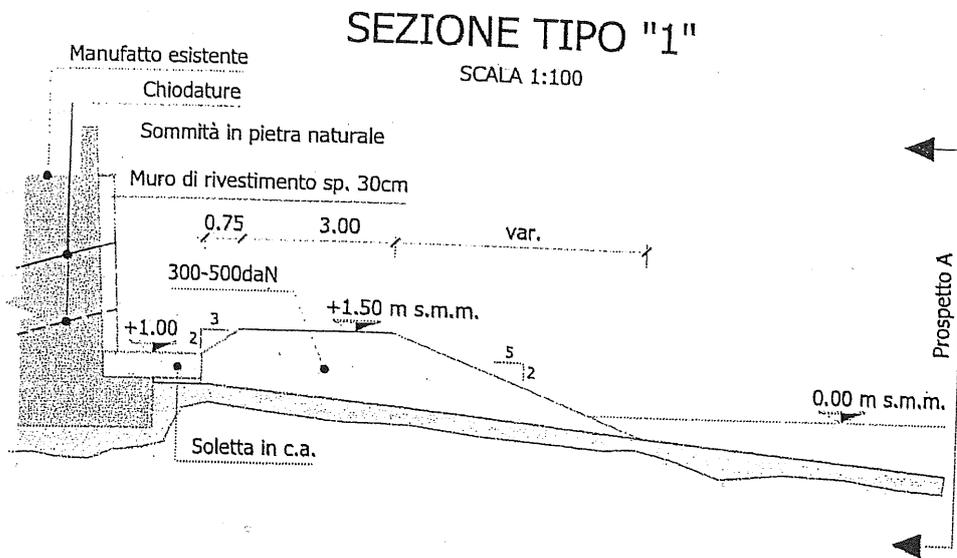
Sezione tipo 1. Consolidamento del muro e protezione mediante scogliera radente.
